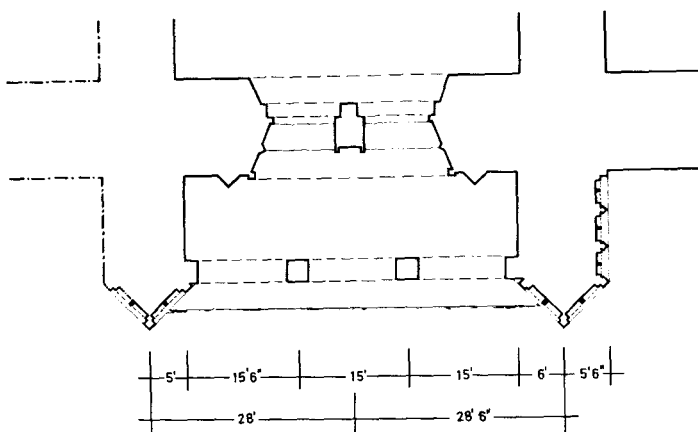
Ulm Münsterturn Riß B, schematischer Grundriß des Vorhallengeschosses.
